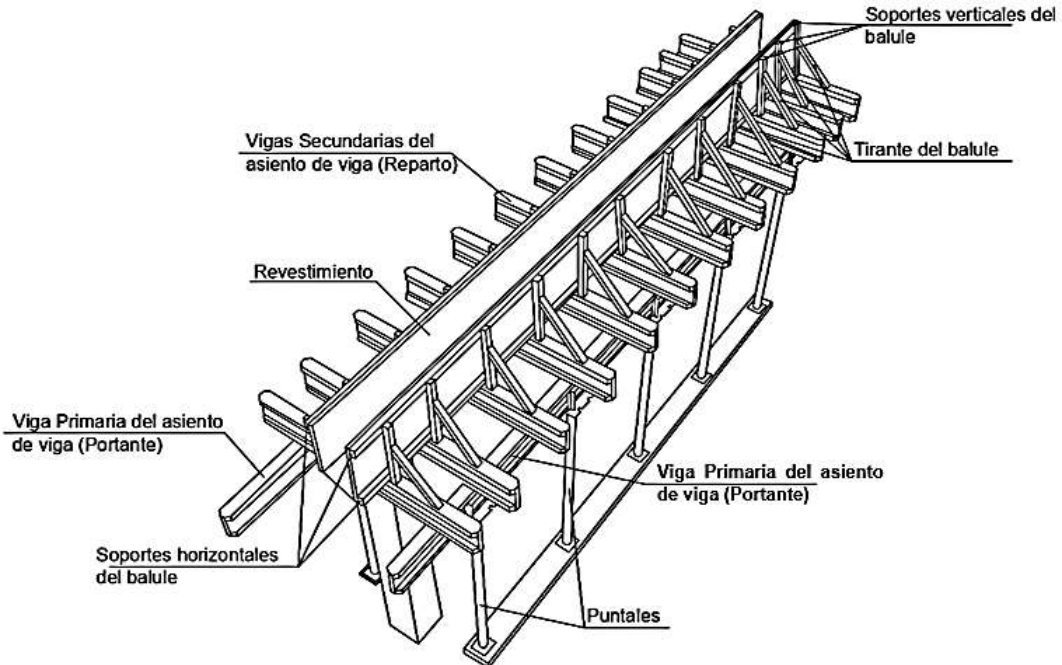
Componentes de un encofrado para vigas de concreto. ARRECONSA, (2018)
